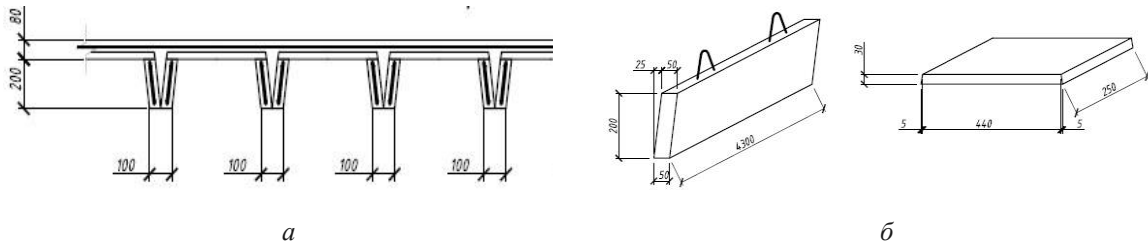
Перекриття зі збірних залізобетонних плиток та балок:
